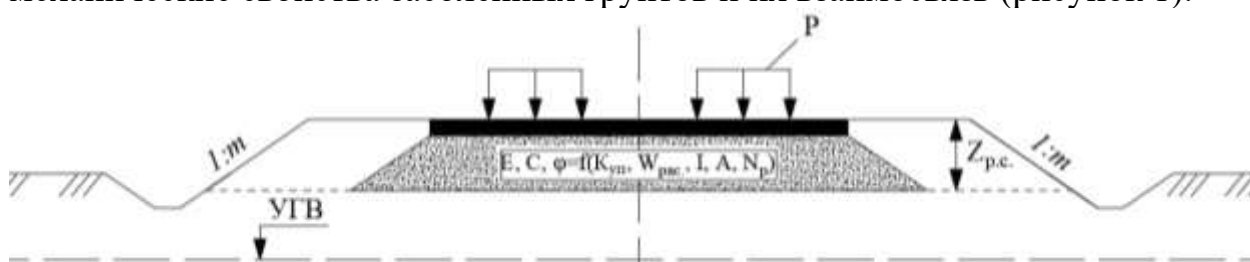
Схема земляного полотна из засоленного грунта в поперечном профиле
